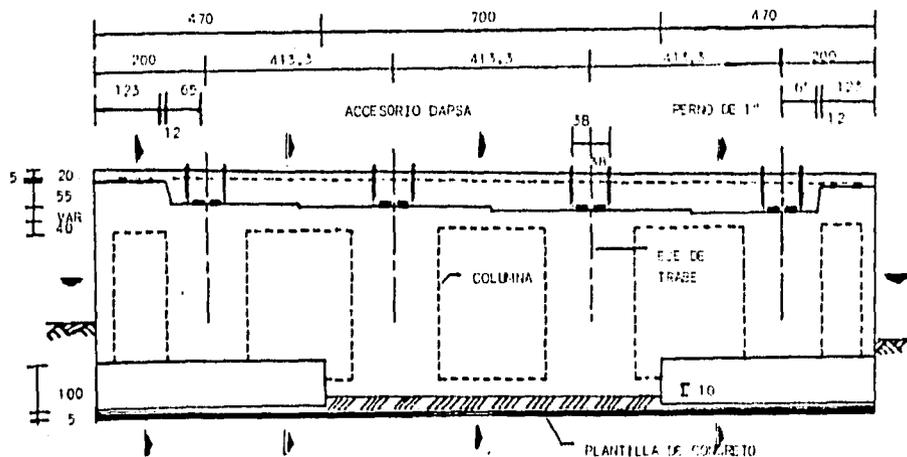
VISTA FRONTAL DEL MURO ESTRIBO
